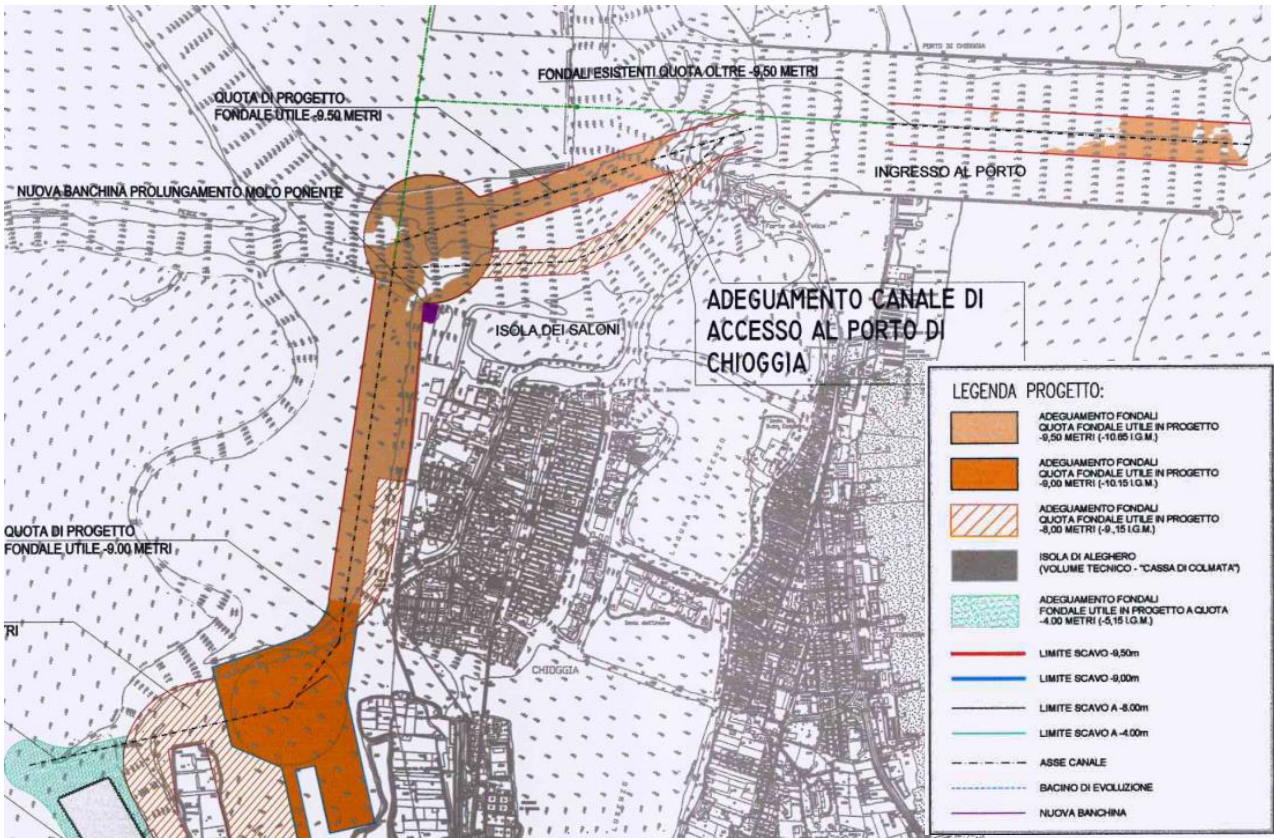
Adeguamento dei fondali di accesso previsti dall'ATF3
